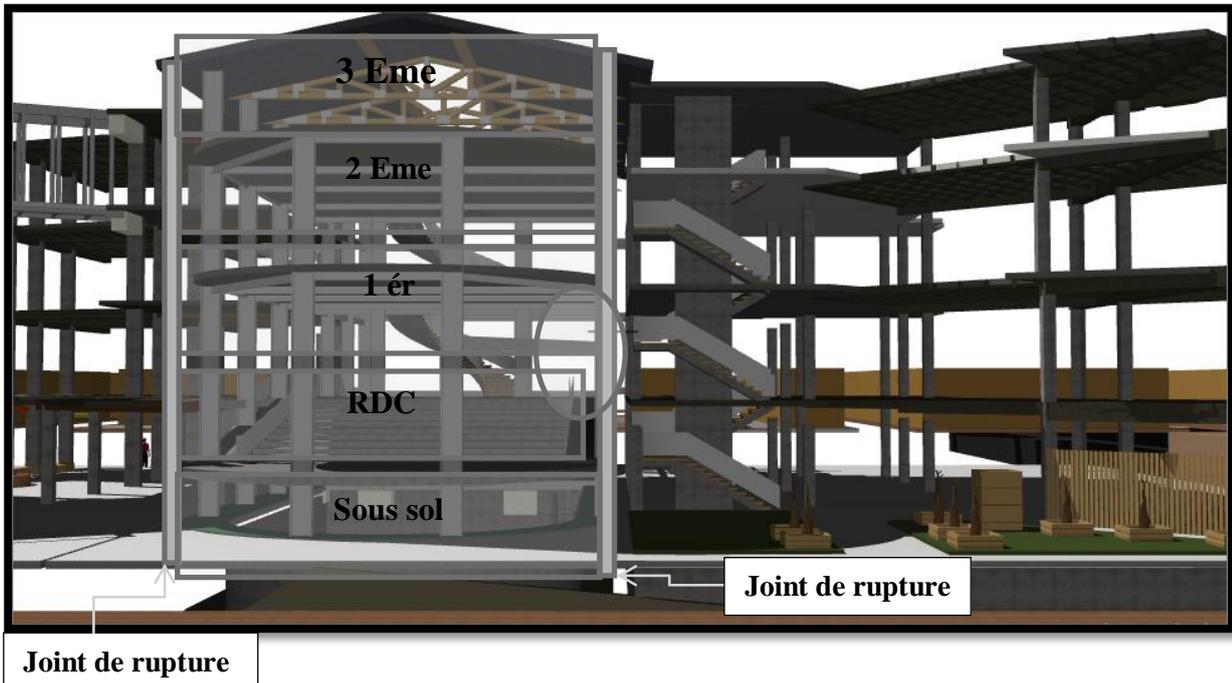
Détails des planchers intermédiaire ajouté et joints
